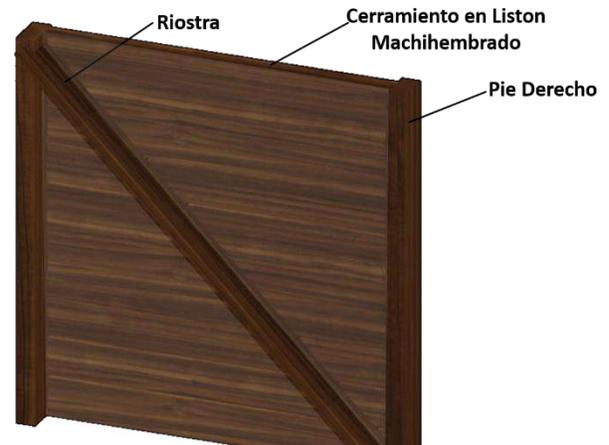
Detalle Muro Divisorio en Madera Fuente: Elaboración Efren Ventura
